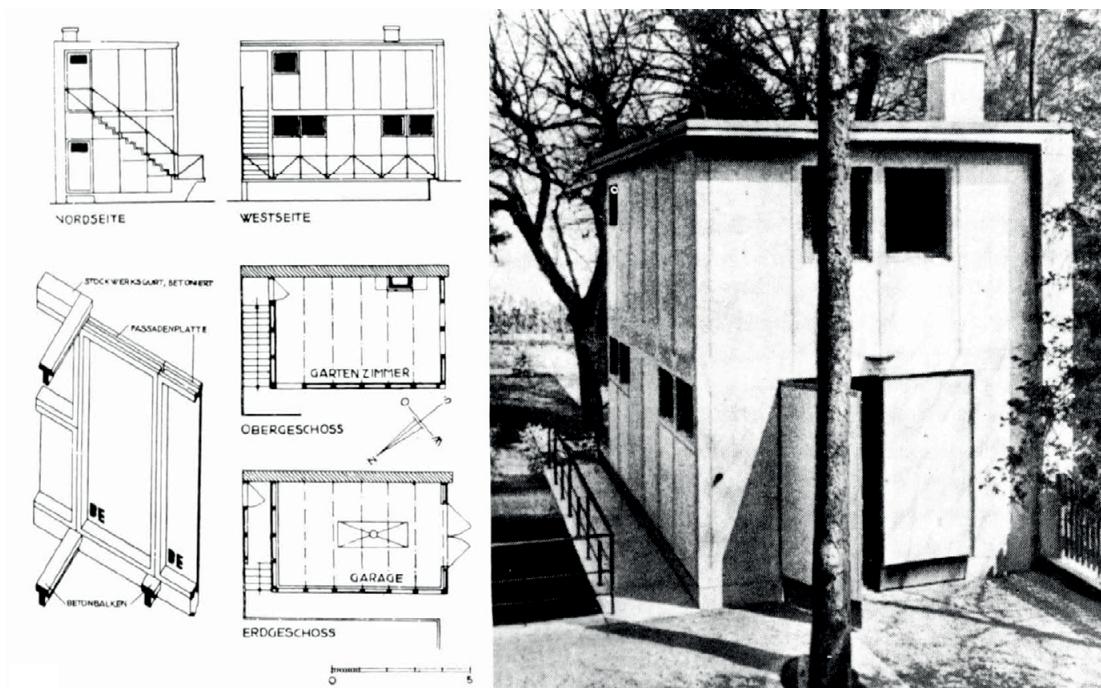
Pabellón prefabricado realizado por Hans Schmidt en Basilea, 1925.
